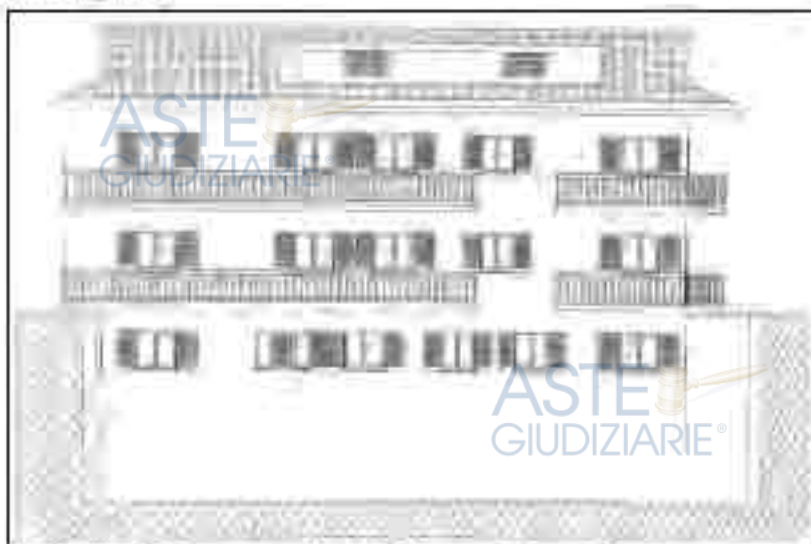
AR. n.68 - piante, prospetti e sezioni - Permesso di costruire in variante e sanatoria del 2008
